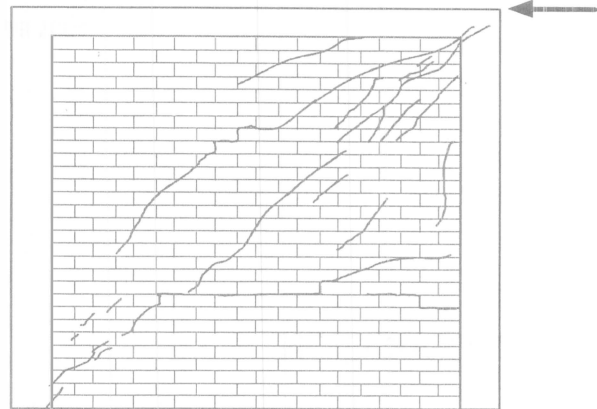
Ensaye en voladizo de un muro de mampostería confinada (Meli, 1979).
